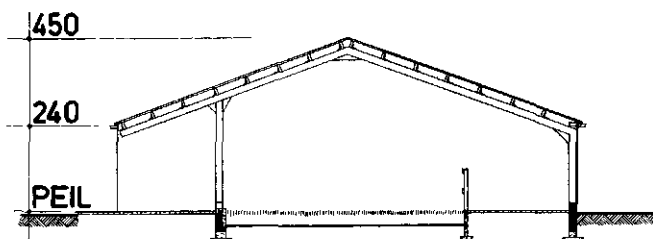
Plan D: doorsnede van een ligruimte met een vrije overspanning. Cross-section of bedded area with clear span (farm D).
